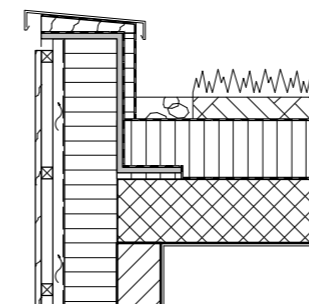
BRÜSTUNGSDetail DACHTERRASSE
